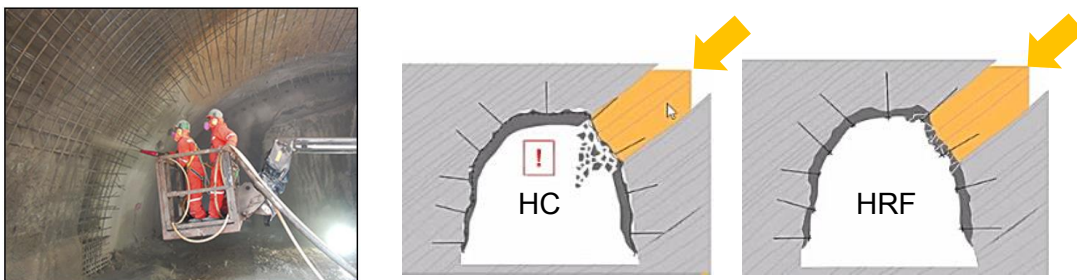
Sostenimiento primario de túneles con hormigón convencional (HC) y con hormigón reforzado con fibras (HRF) Adaptado de (Rey, 2020)
